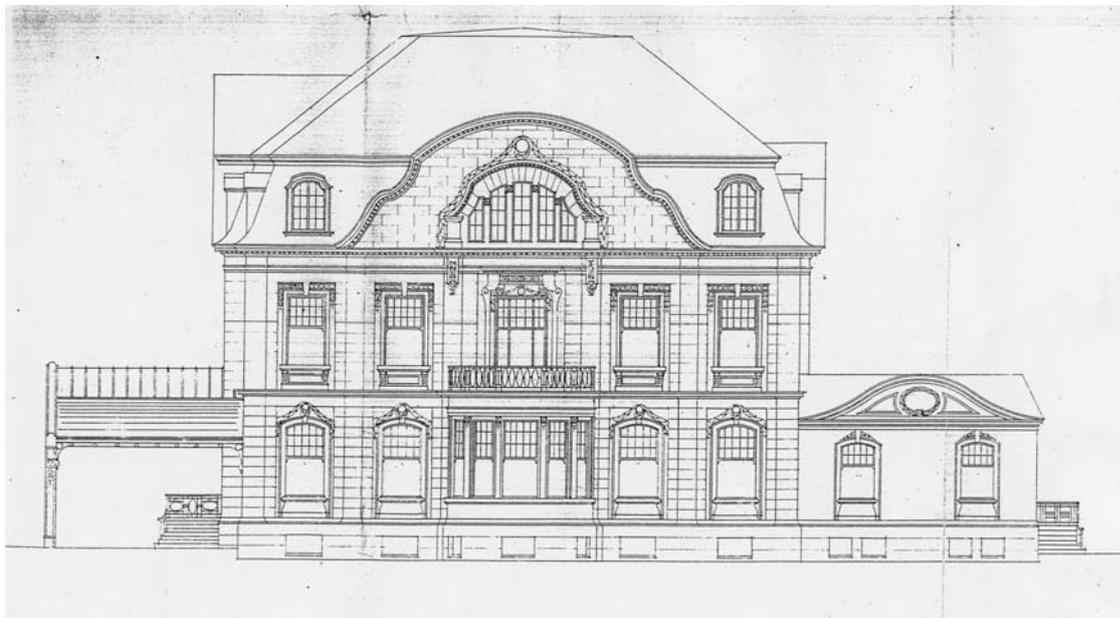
H. Plange, Wohnhaus Röder, Hauptfassade zur Straße, Aufriss 1904
